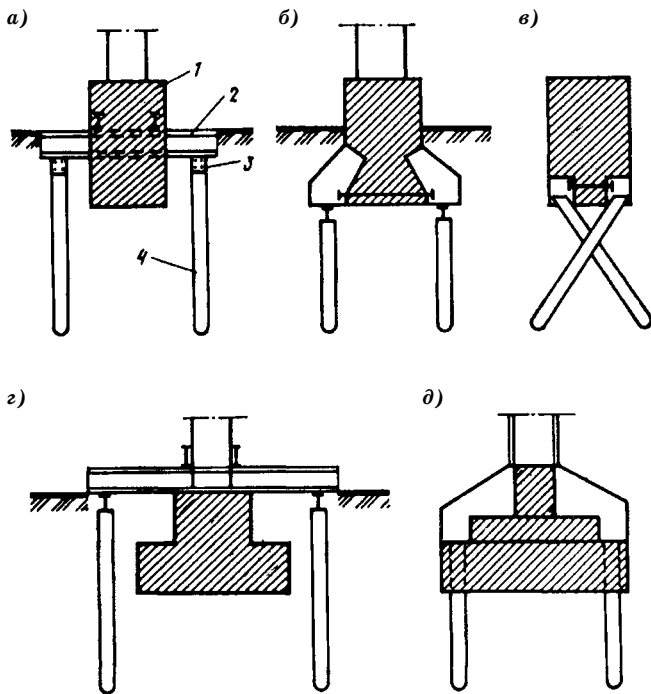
Усиление ленточных и одиночных фундаментов набивными сваями:
